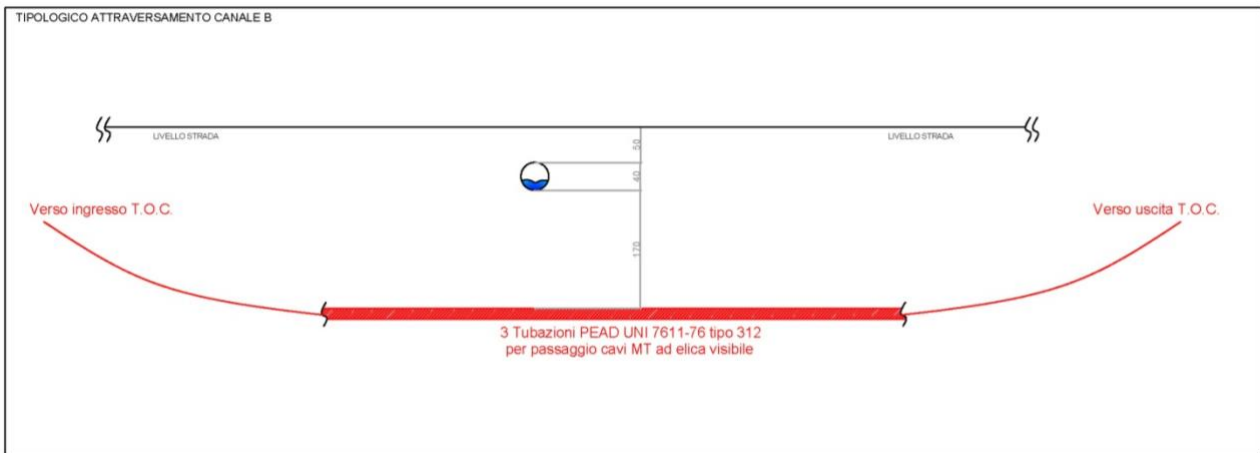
Dettaglio attraversamento in T.O.C. canale B
